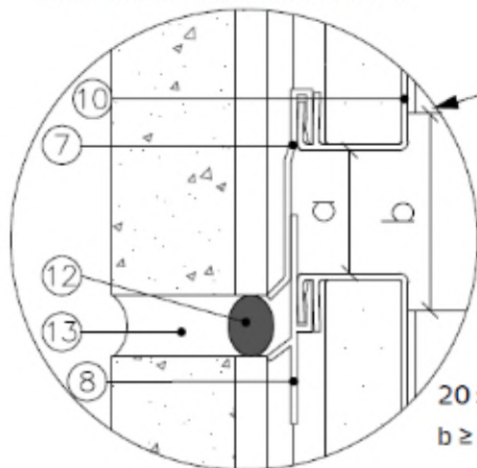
Fractionnement de l'ossature avec bavette au droit de chaque plancher sur béton
